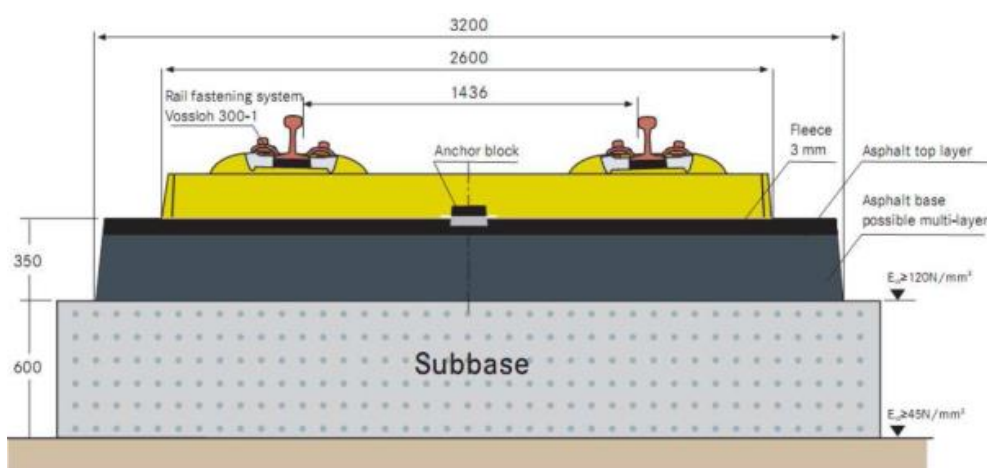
Perfil transversal esquemático da solução GETRAC A1 (Rail.One, 2007a)
